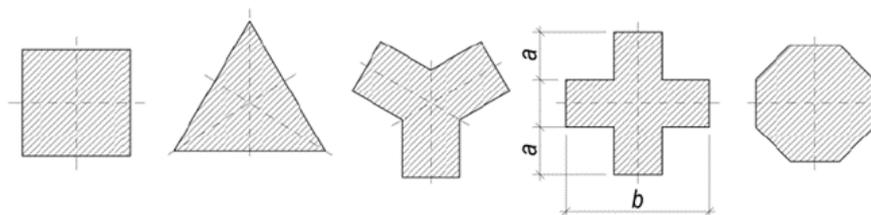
Фундаменты, испытанные Глушковым А.В., с измененной плоской подошвой.
